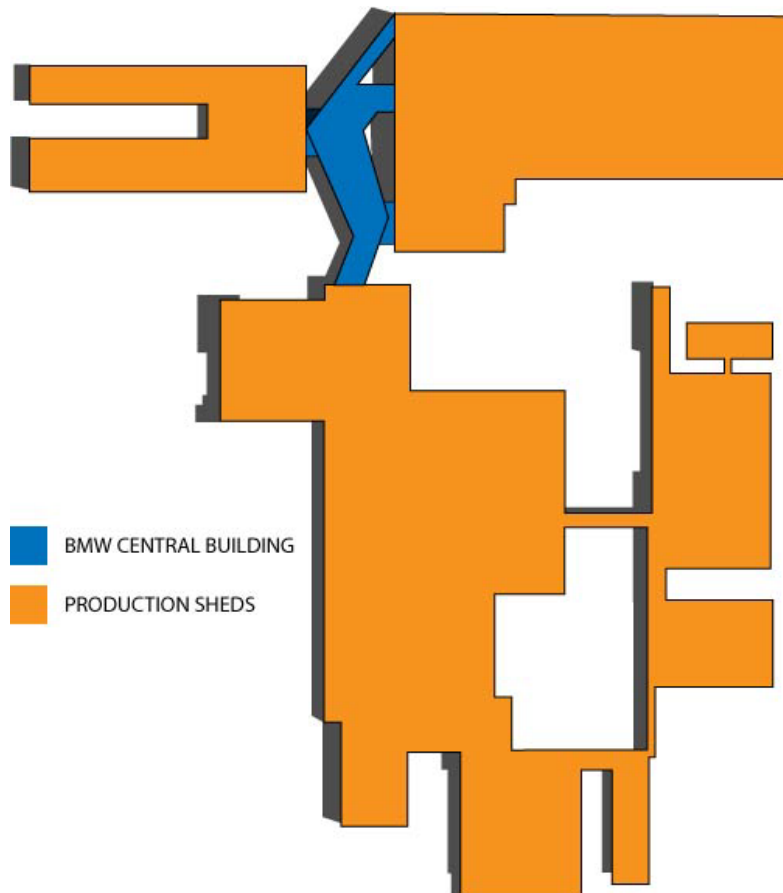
Schema funzionale dello stabilimento nel suo complesso.
